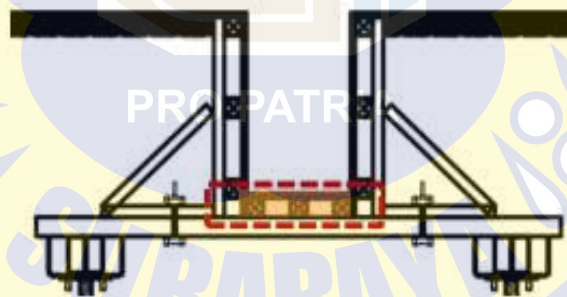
Perencanaan Desain Bekisting Balok
